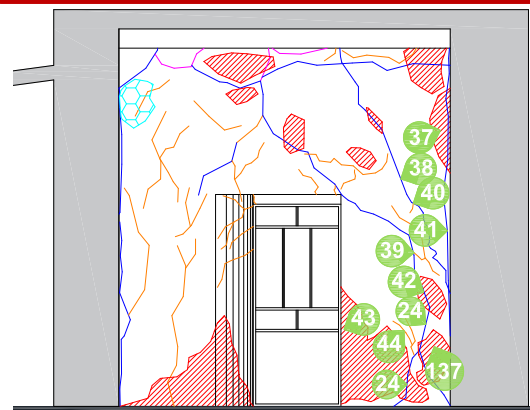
Detalle de fractura presente en unión de cubierta y muro interior norte
